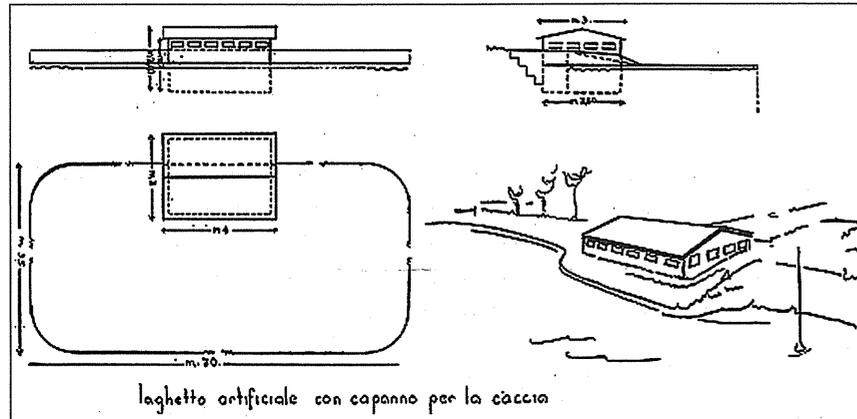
Progetto per la costruzione di un guazzo (Archivio Opere Laiche Lauretane).
